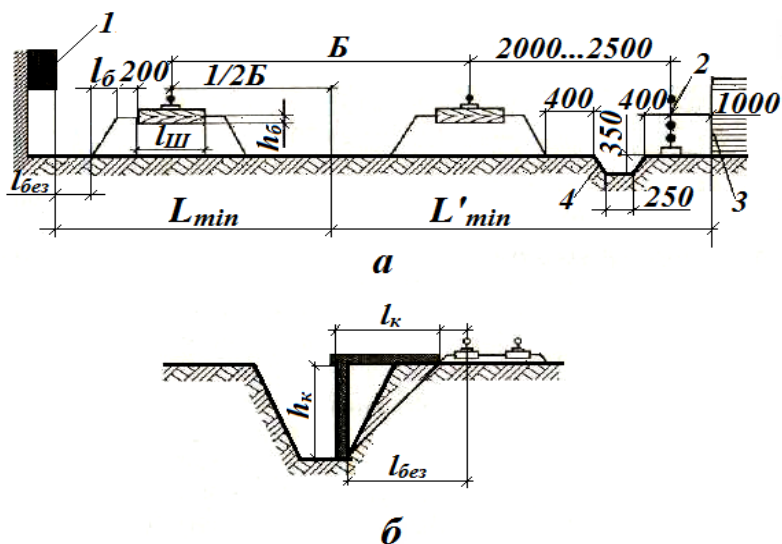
Схема для расчета поперечной привязки подкрановых путей:
